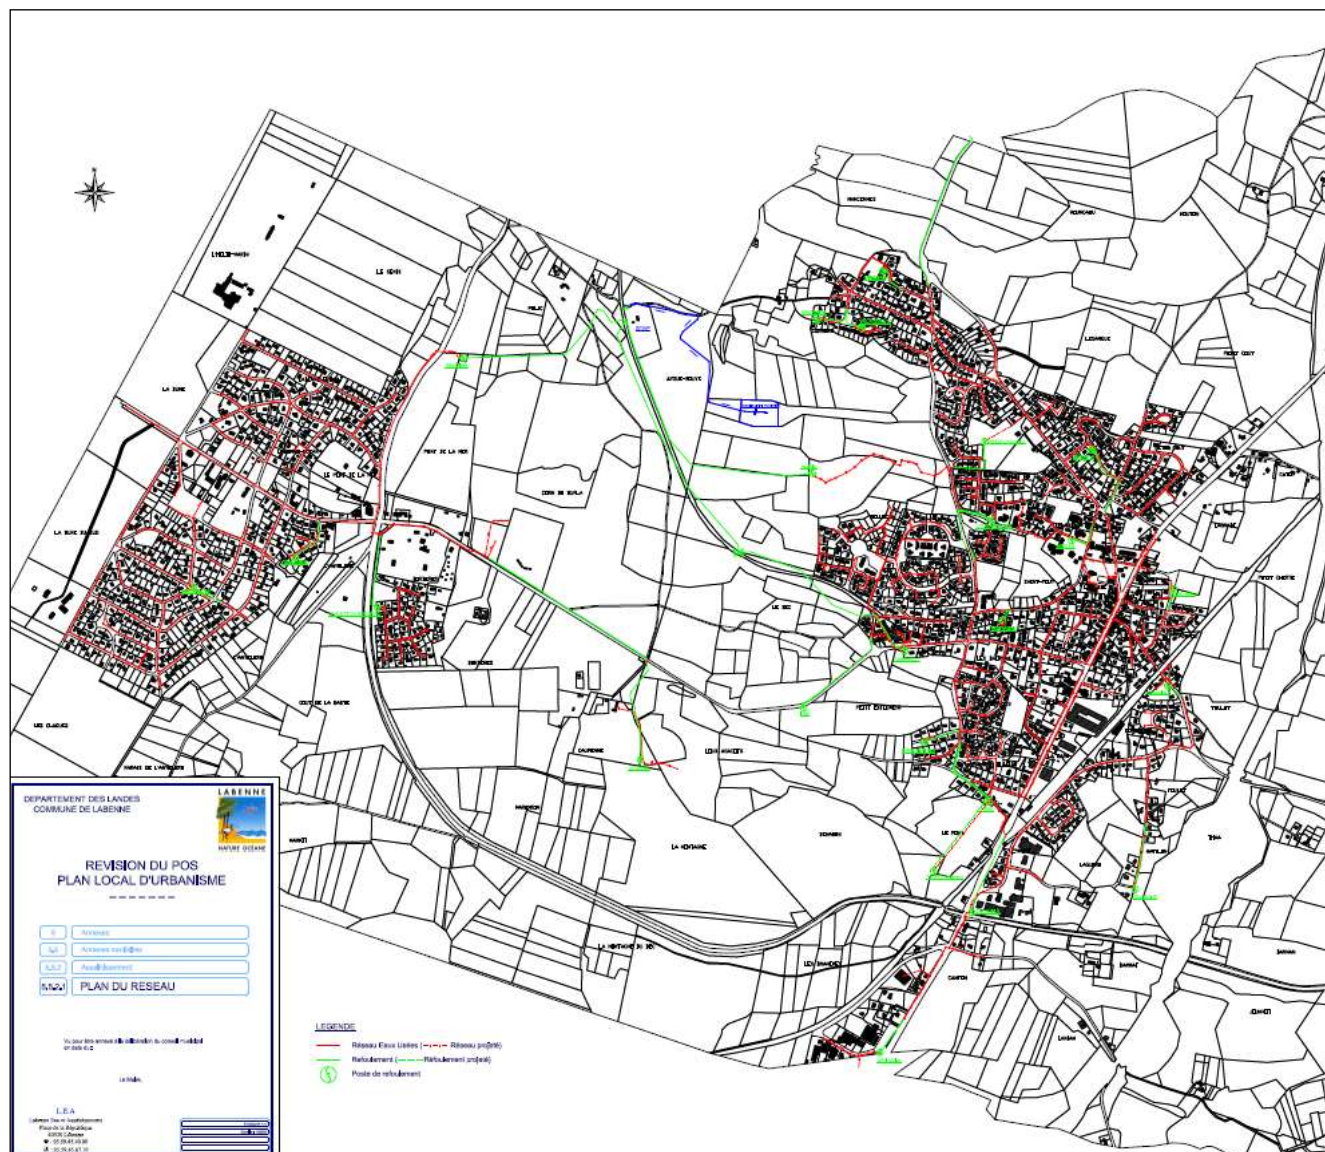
Plan général des réseaux d'assainissement en vigueur sur la commune de Labenne
